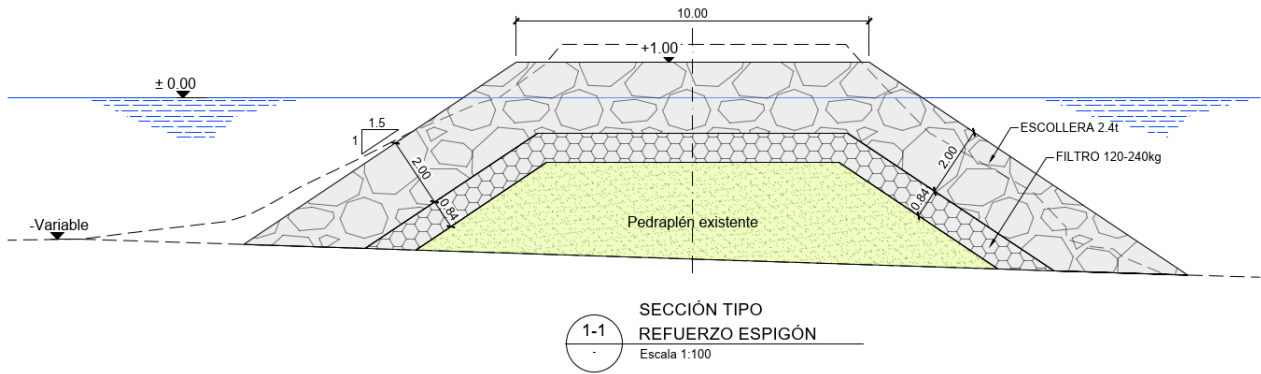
Sección tipo propuesta de refuerzo de espigón.
